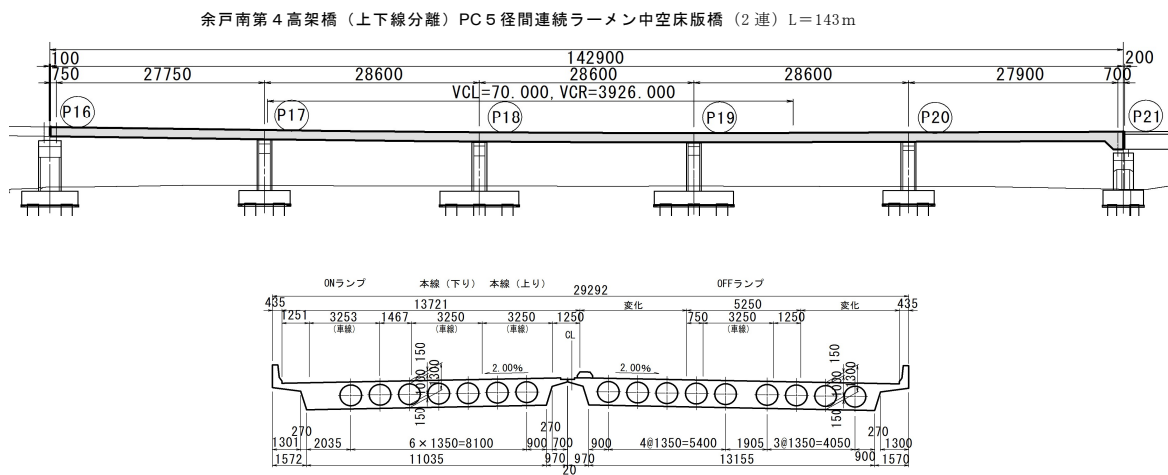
全体一般図 (上:側面図 下:断面図 単位:mm)
